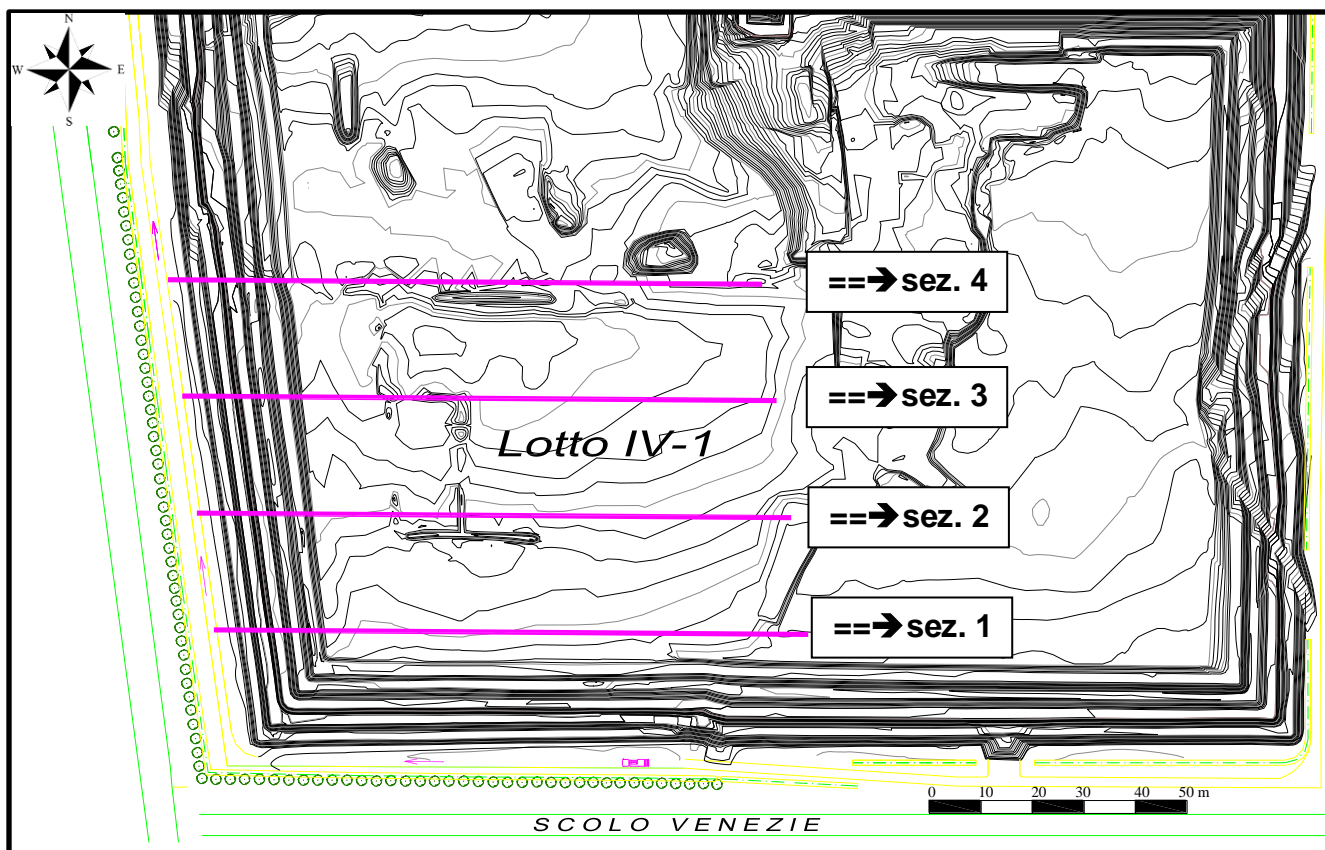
ubicazione profili ERT – corpo di discarica Lotto IV-1° stralcio
